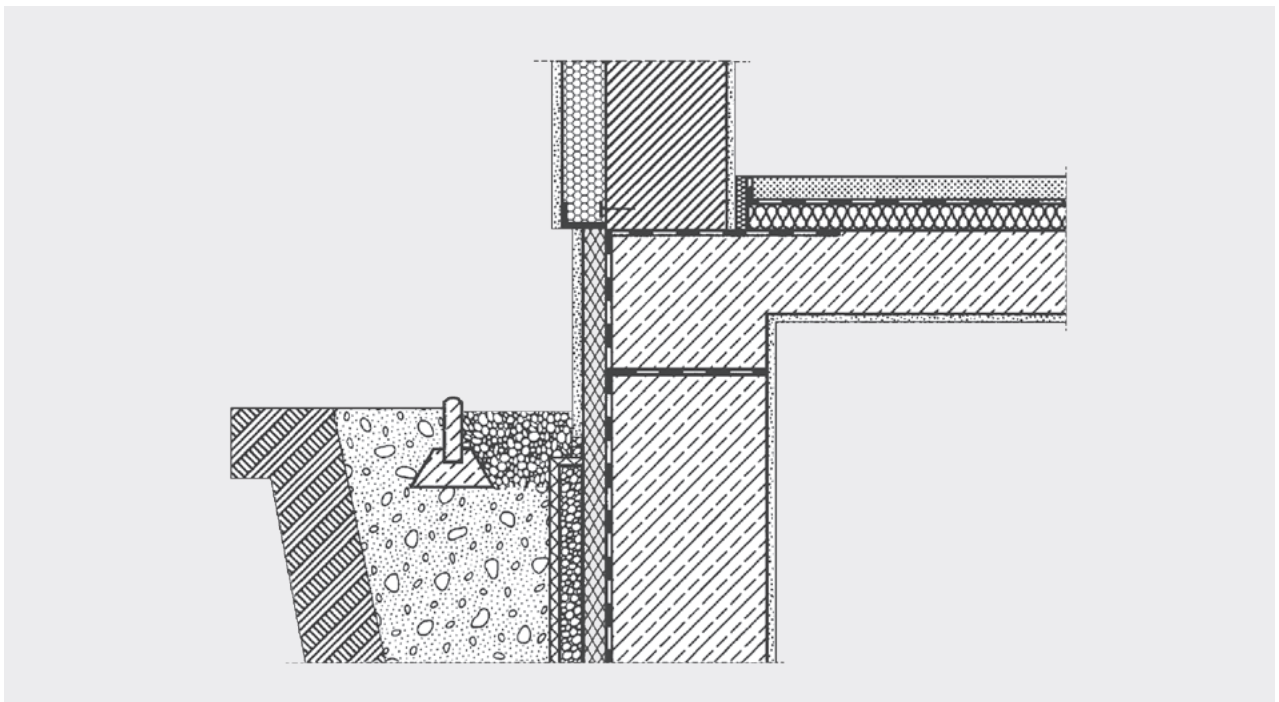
Sockelbereich, wärmebrückenfreier Anschluss der Perimeterdämmung an das wärmedämmende Mauerwerk oder an das außenliegende Wärmedämmverbundsystem
